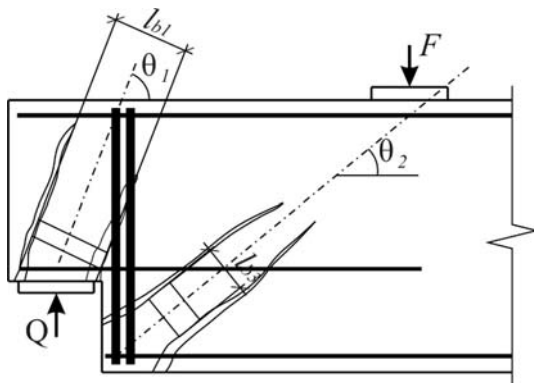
Фрагменты физических и условных грузовых и опорных площадок
